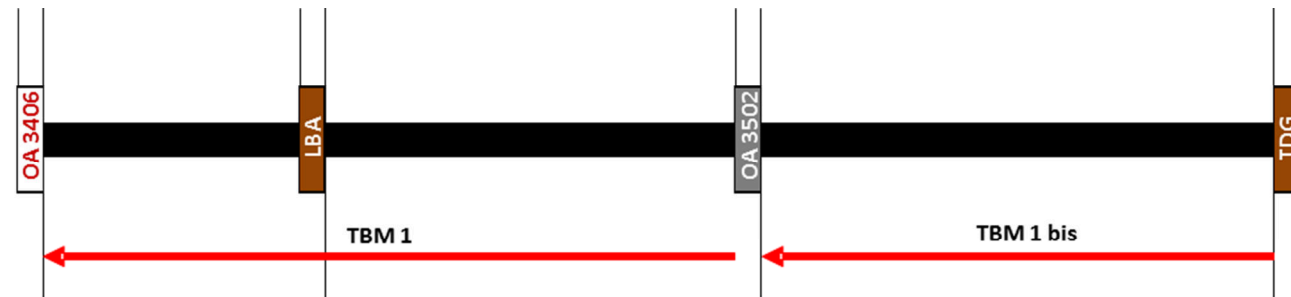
Cinématique du tunnelier pour le creusement du tunnel Sud
